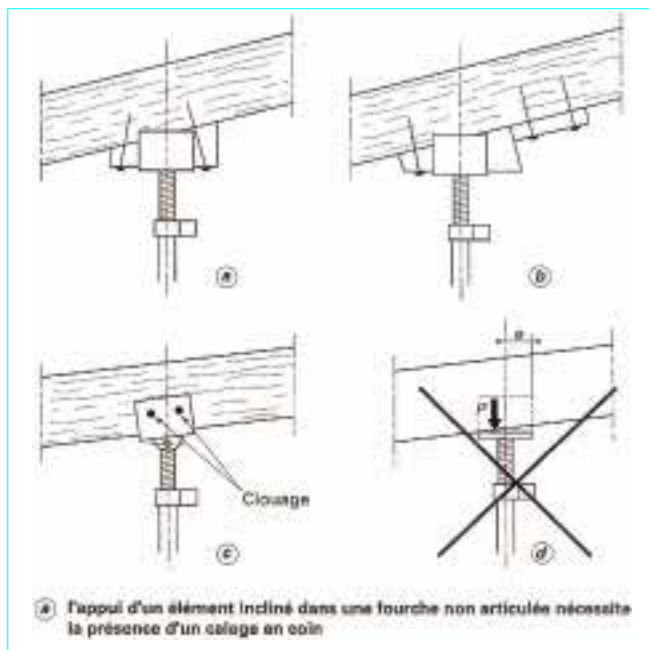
Transmission des charges des coffrages sur le fond de fourche
